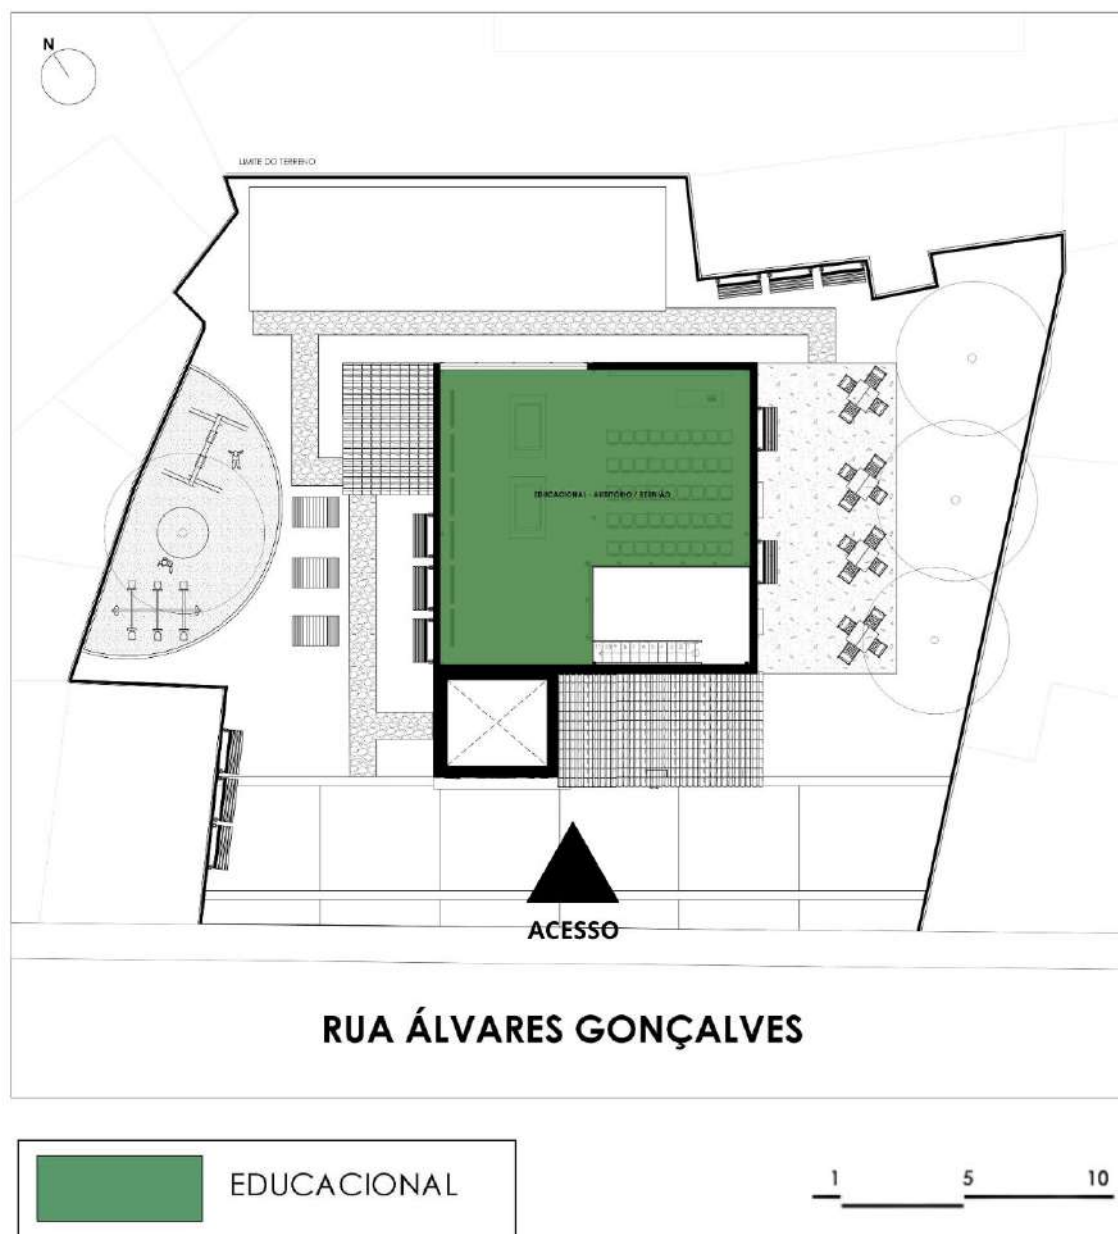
Setorização proposta pavimento térreo da estação de Vila de Cava.
